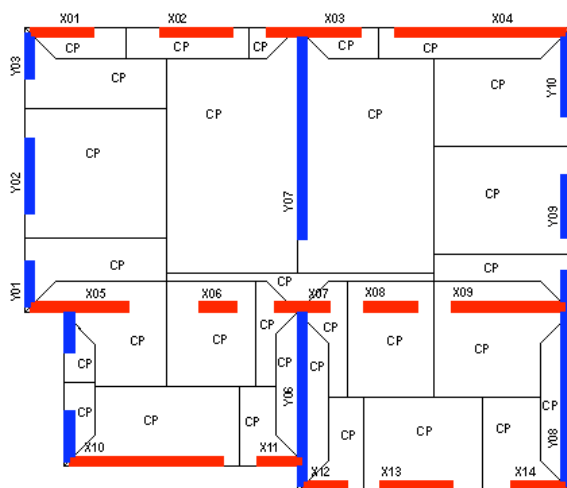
Pianta piano copertura – Aree di solaio gravanti sui maschi murari del piano terra
